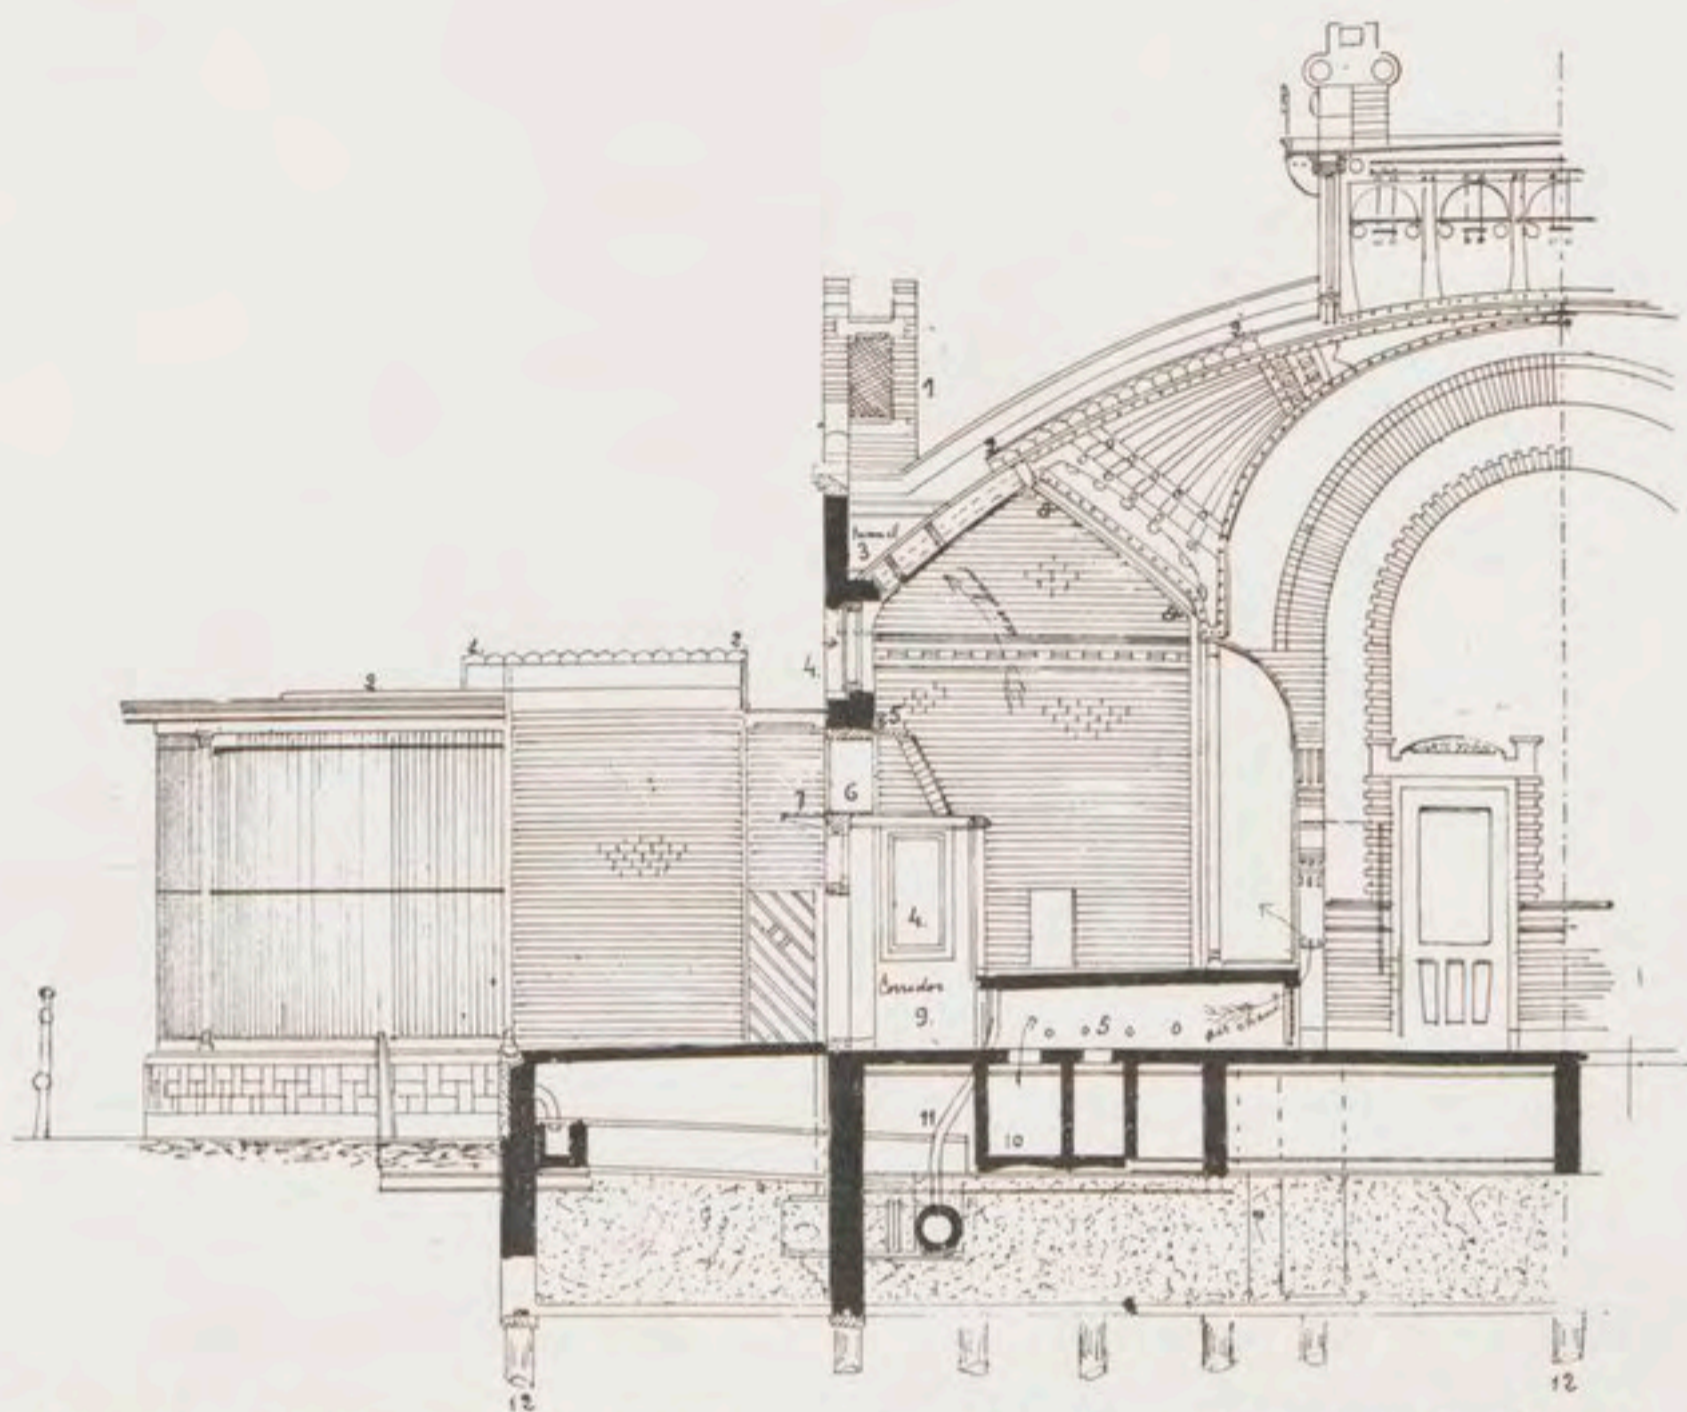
ROTTERDAM. Section transversale de la nouvelle maison des Singes.
